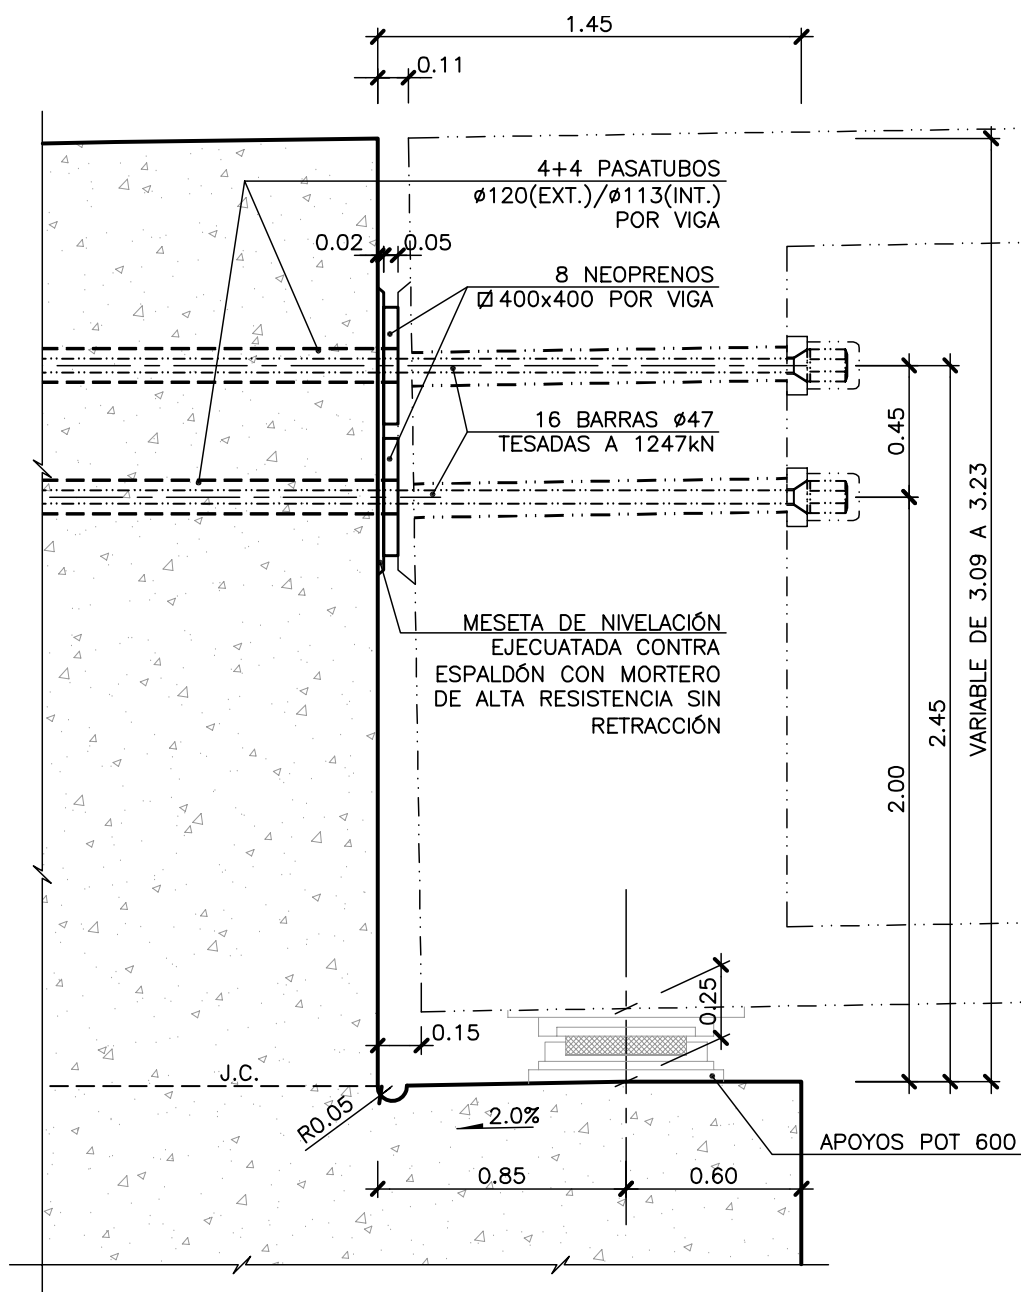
Estribo fijo de tablero de vigas prefabricadas continuas. Detalle de anclaje
